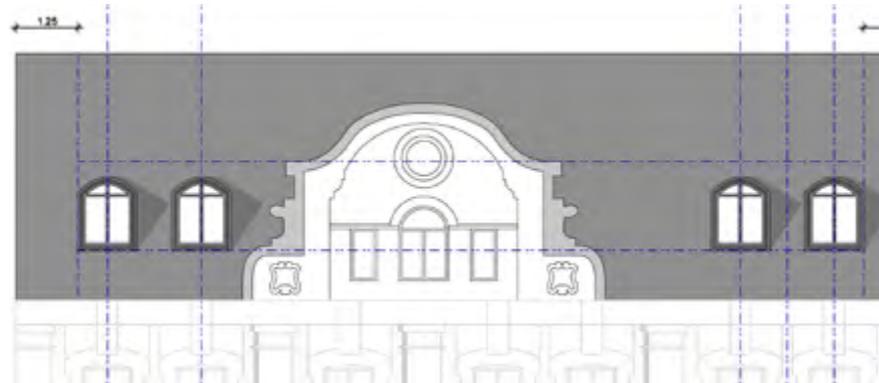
Denkbare Aufbauten der Dachlandschaft im Fassadenraster
